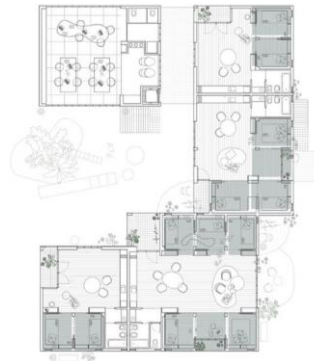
Recorte de la planta del conjunto de vivienda colectiva, indicando en color la herramienta utilizada. Fuente: Elaboración propia.
